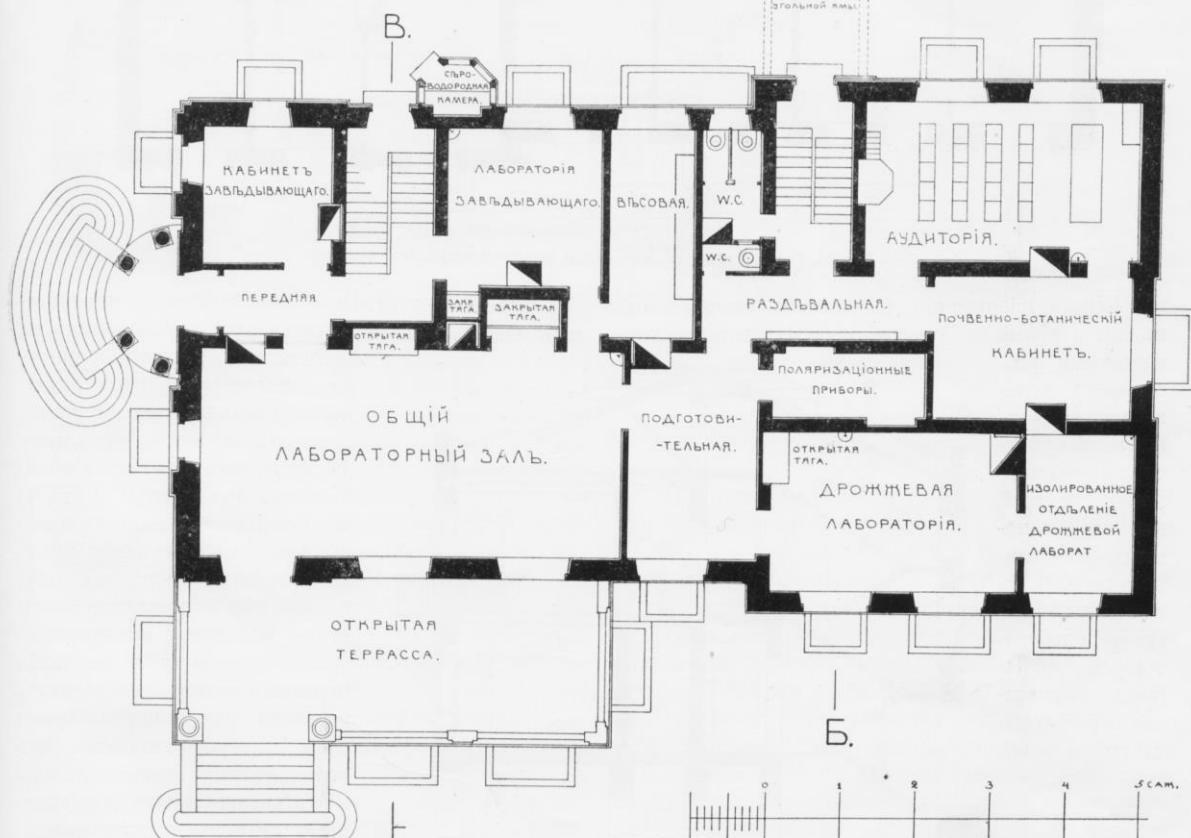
Главное зданіе Станціи. Планъ средняго этажа (съ натуры).
